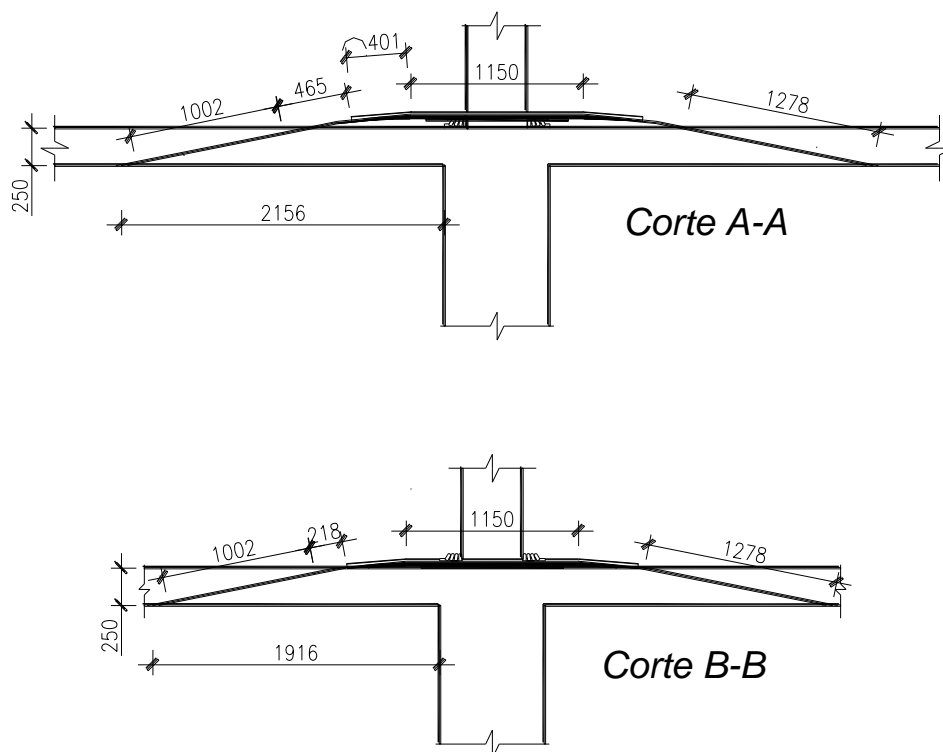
Cortes da pormenorização do reforço no pilar P1 (desenho sem escala e dimensões em mm).
